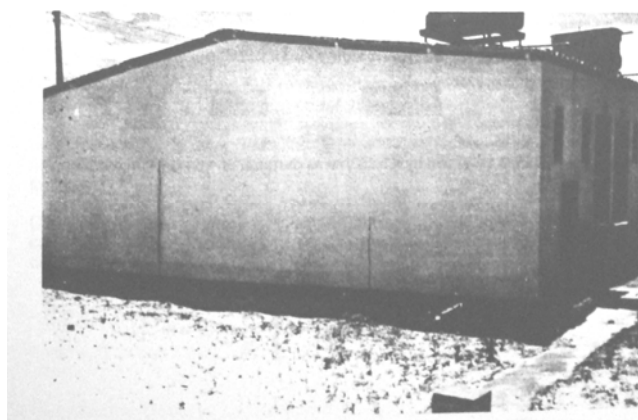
Fissura em parede monolítica relativamente extensa, provocada pela retração do concreto
